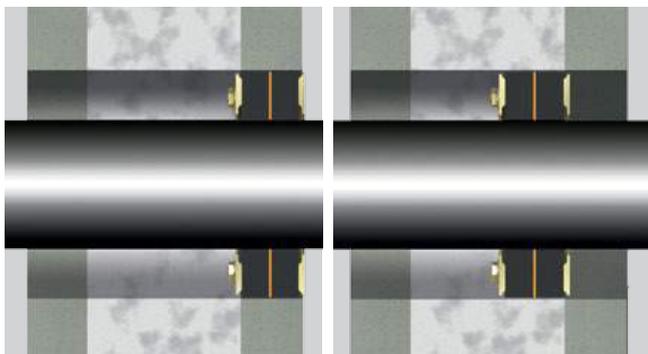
Niveau d'étanchéité: élément préfabriqué
